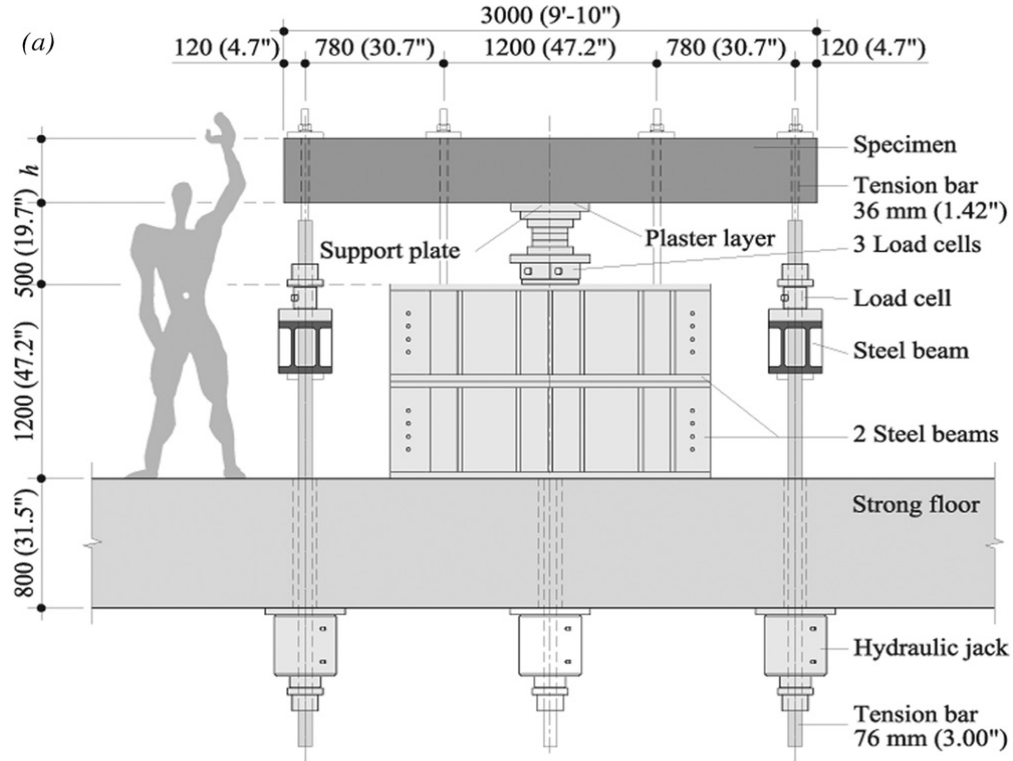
Detalhes da configuração do ensaio [6]
